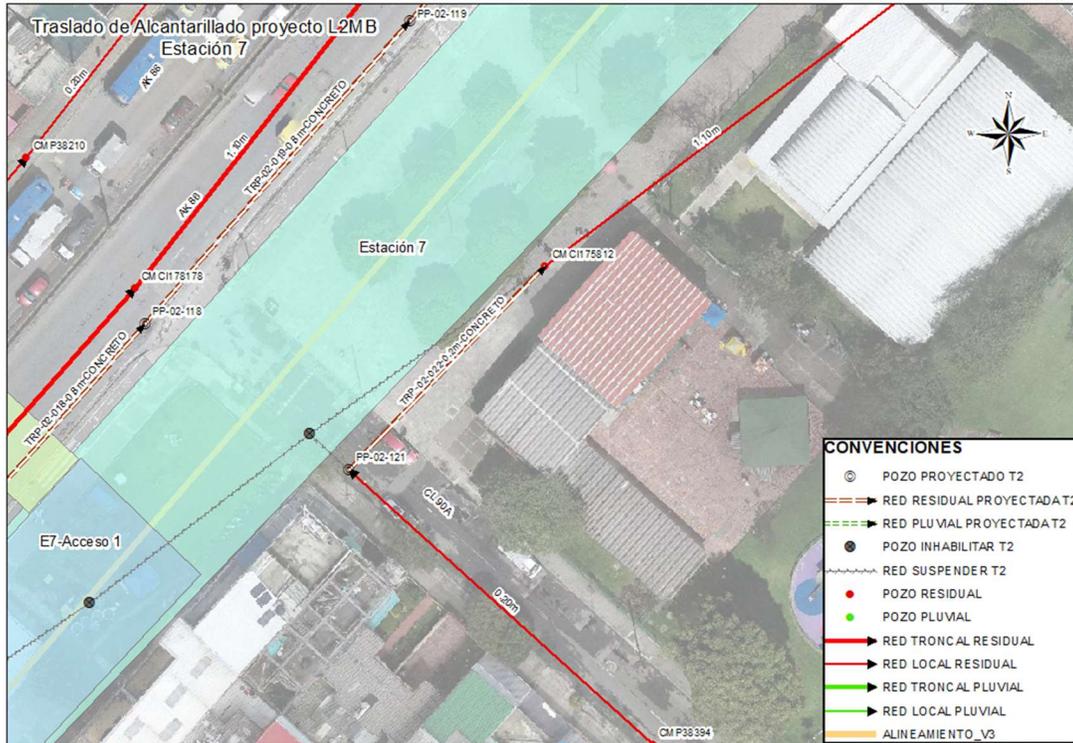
Traslado redes de alcantarillado Estación 7 Carrera 86 con calle 90A Red Residual
